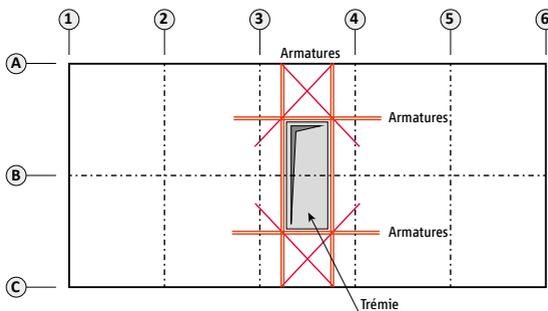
Solution de renforcement avec des armatures autour de l'ouverture et des barres complémentaires en diagonale
